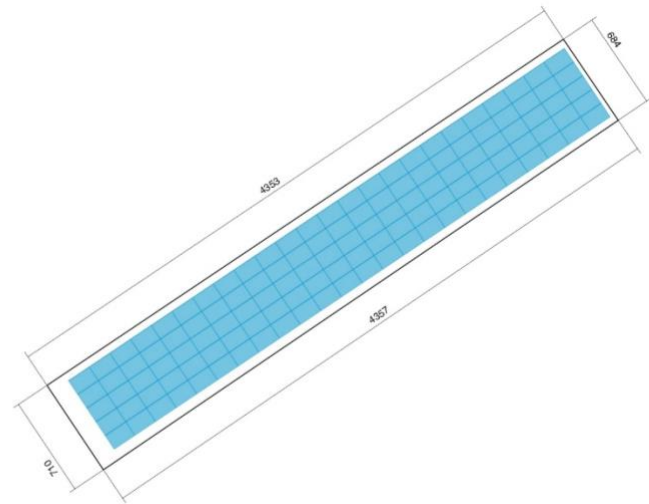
Schulhausstrasse 11, Belegungsplan, Dachfläche 1
